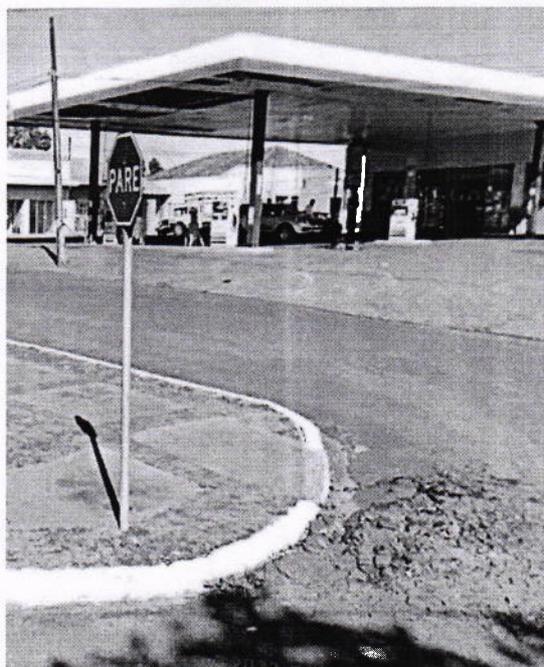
Rebaixo de acesso B. Fonte: Autora
